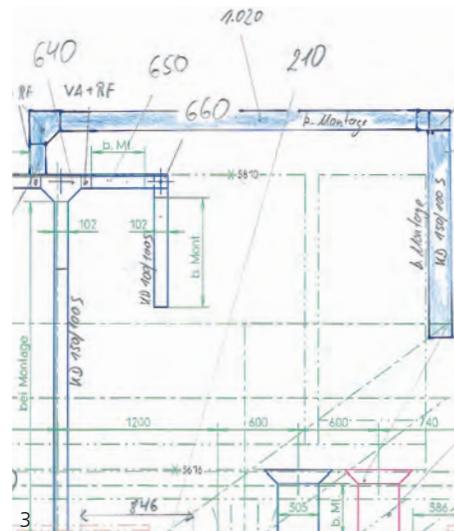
Dreidimensionale Streckenführung mithilfe vieler Formteile
